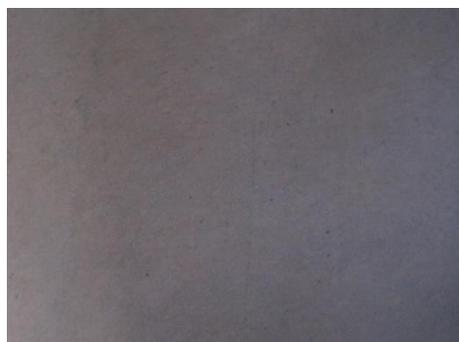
Pavimento da Igreja de Arroios em Lisboa
